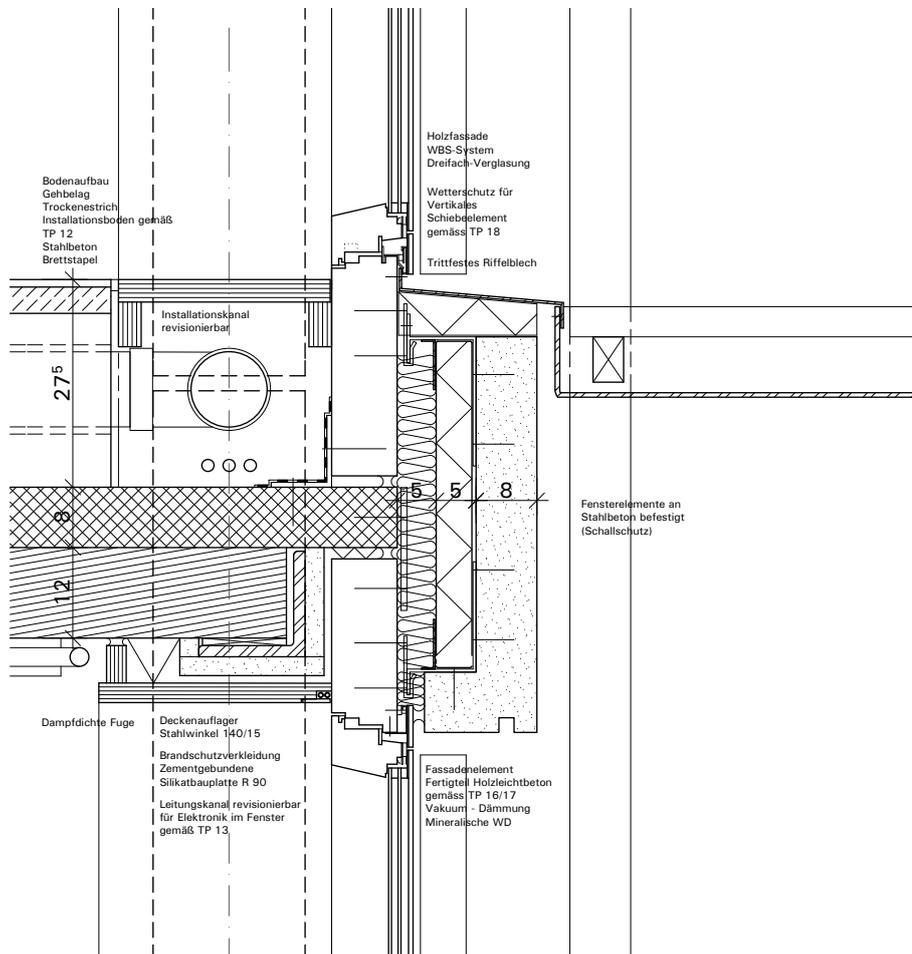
Vertikal- und Horizontal-schnitt M 1:10 der Fassadenvariante mit Stützenabstand 1,35 m
